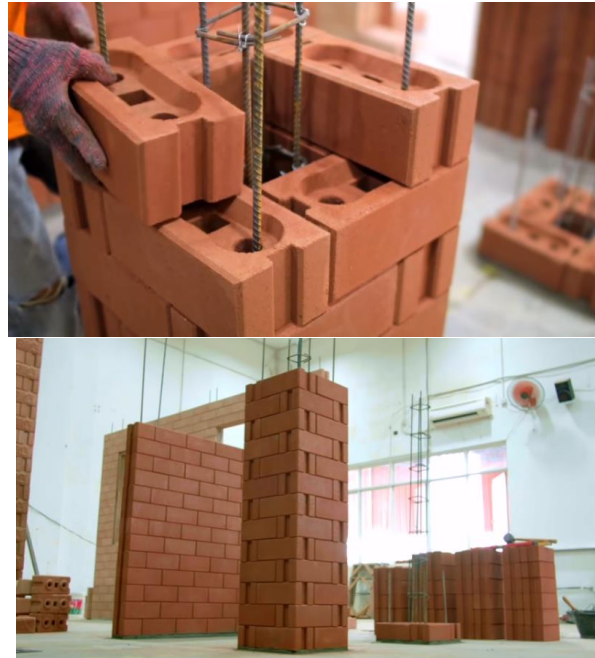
colocado de aceros en el medio de los bloques, para su reforzamiento
